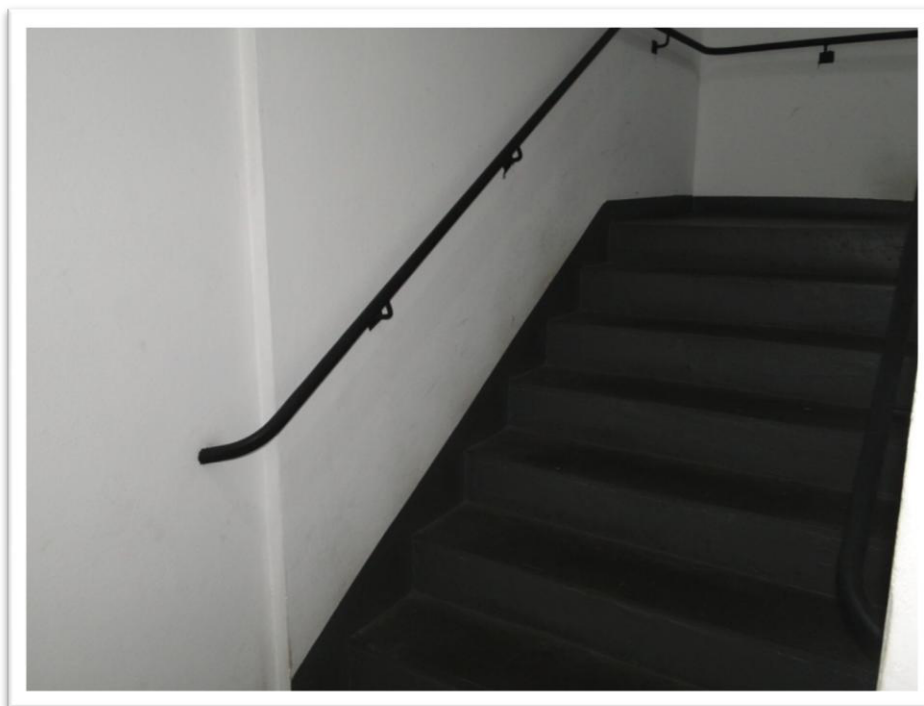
Vista parcial sob outro ângulo da escadaria do prédio.
